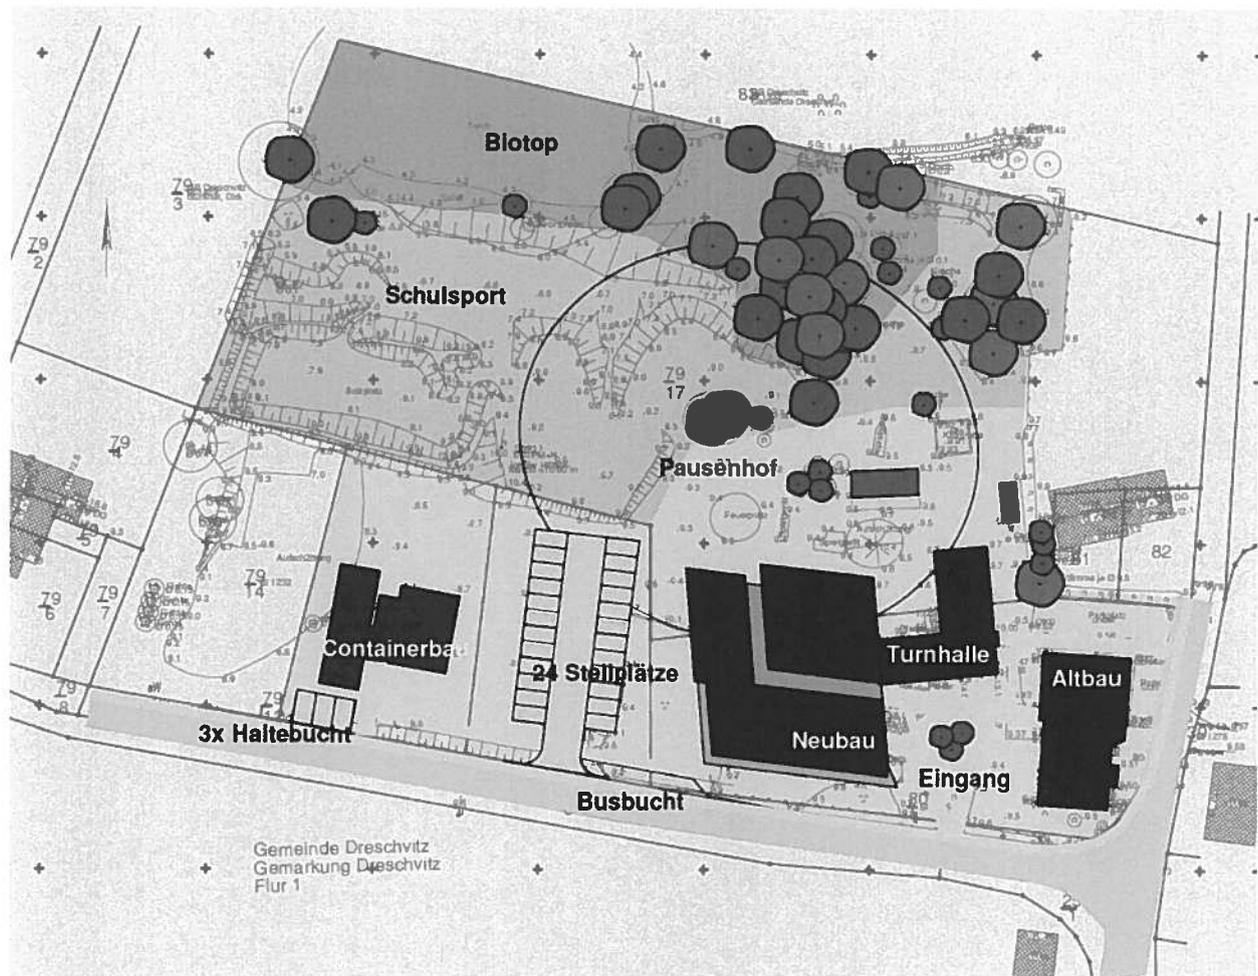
Städtebaulicher Lageplan mit Funktionsbereichen
